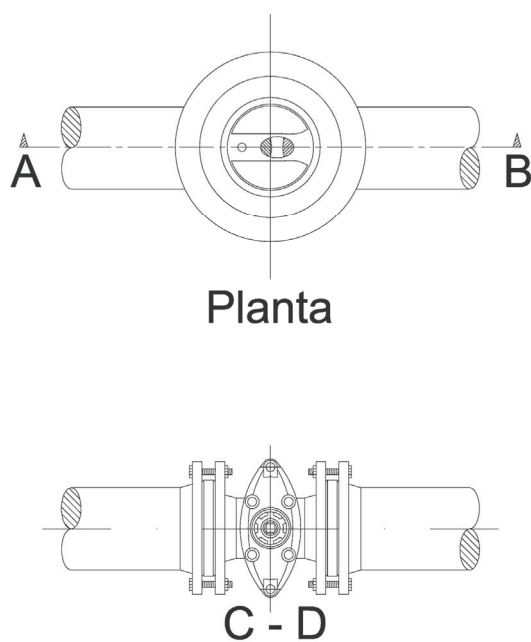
Perfil de implantação tipo de uma válvula de seccionamento (cortes)
